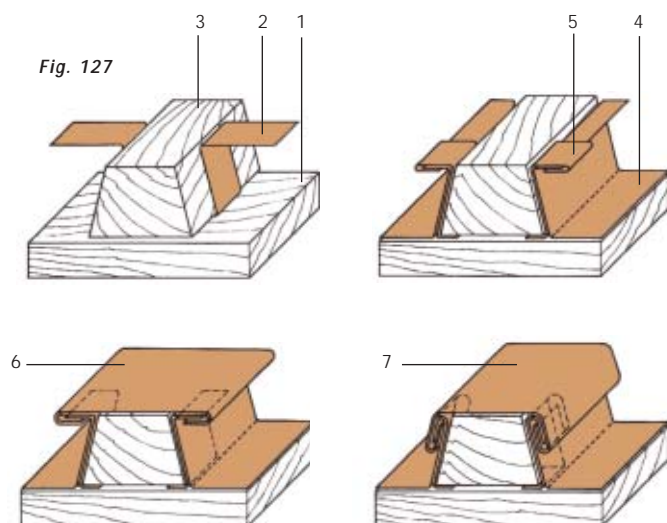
Detalhe construtivo das juntas elevadas com caibros.
